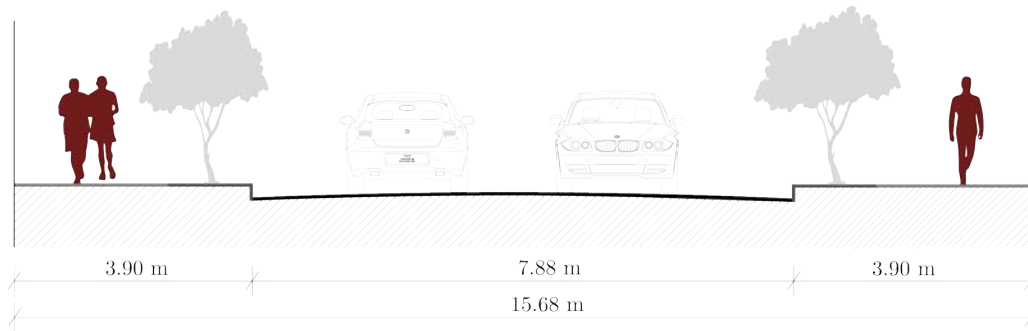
Sección vial de la Av. Collao. Elaboración: Propia.
